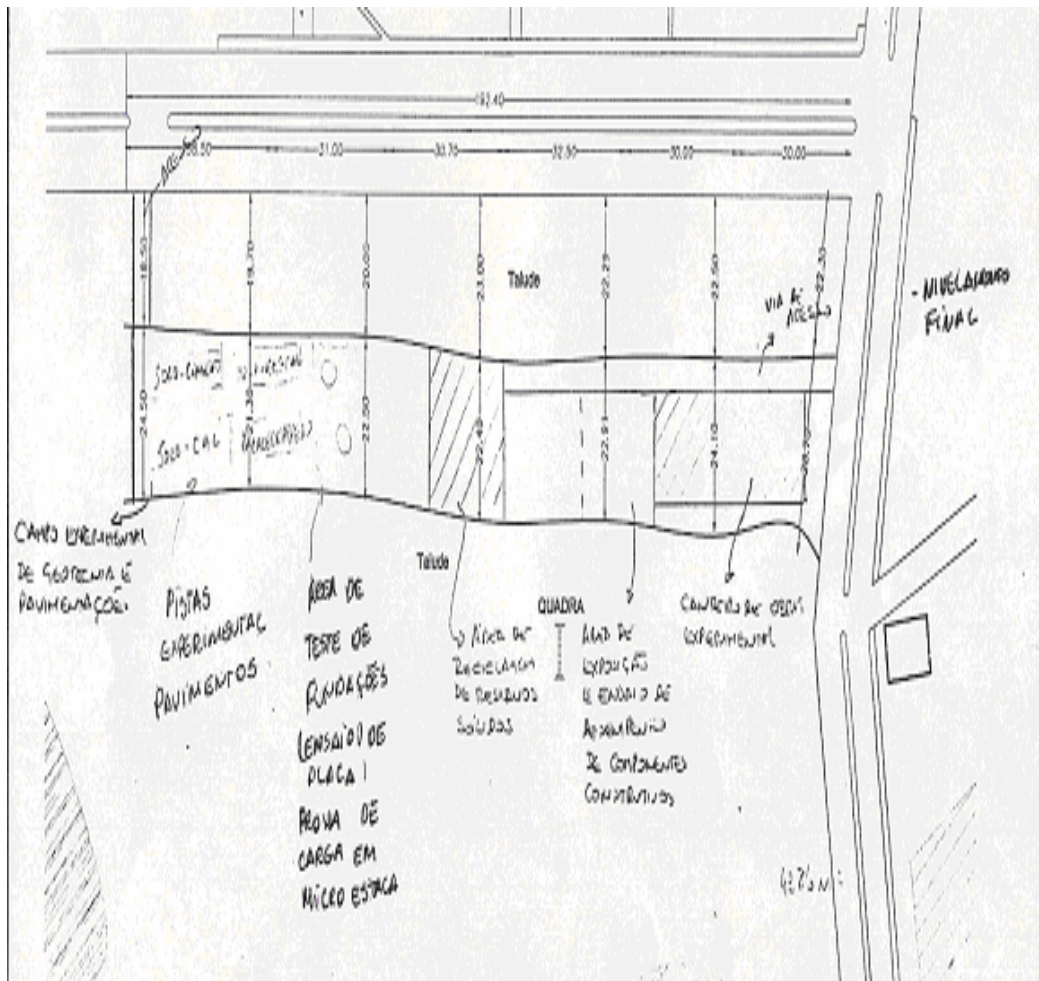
Esboço da primeira implantação do CETEC-UPF.
